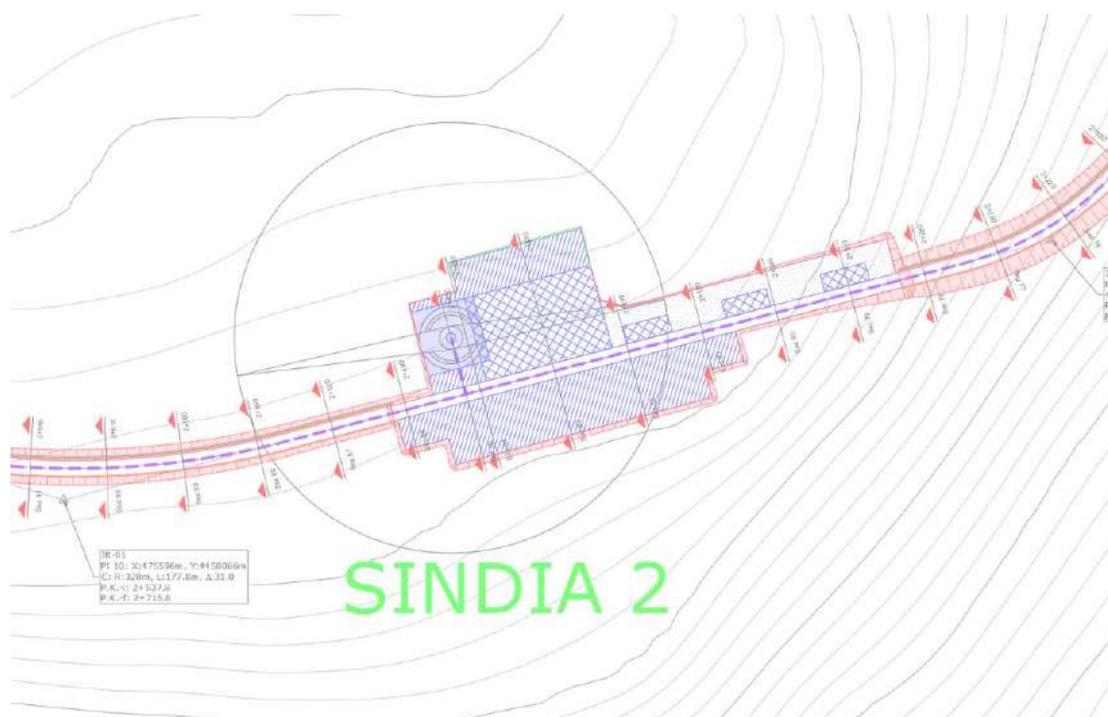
Tracciato planimetrico viabilità di nuova realizzazione.
